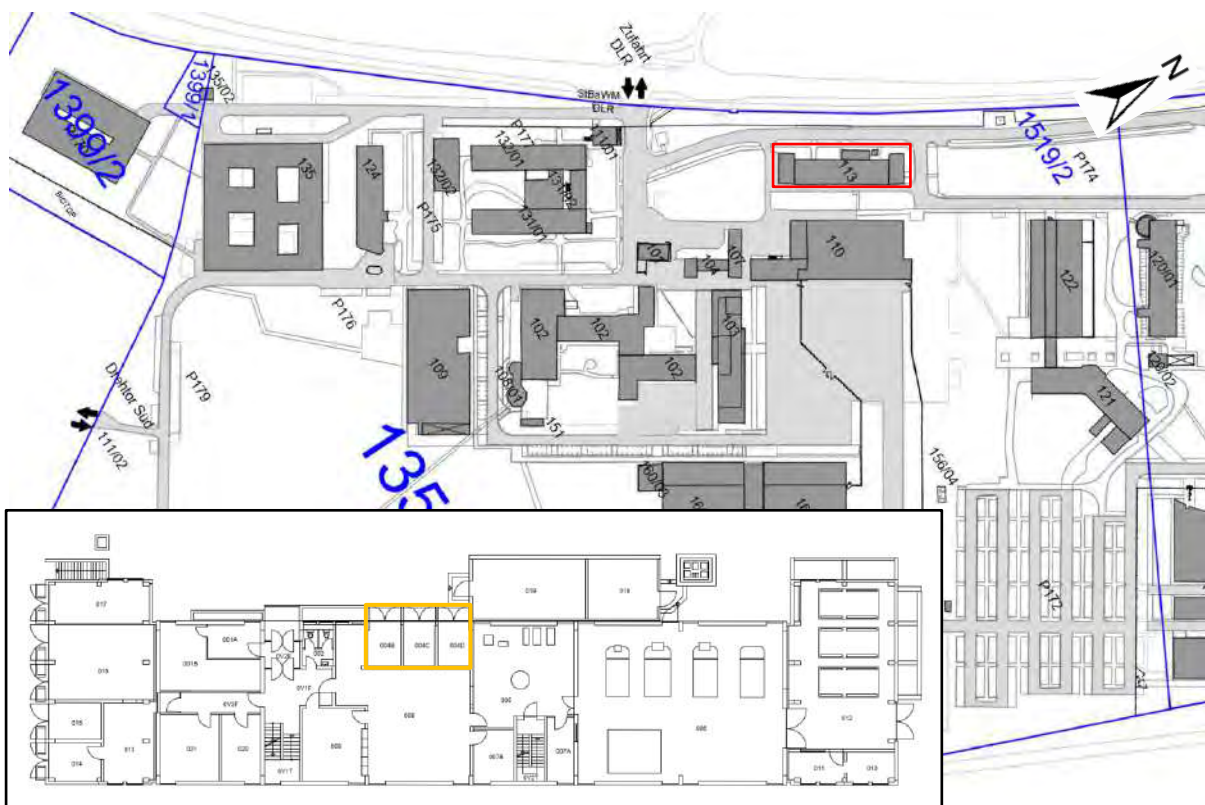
Lage von Gebäude 113 (rot). Ausschnitt aus [6]. Im EG-Grundriss Lage der Traforäume als orangene Markierung [23].
